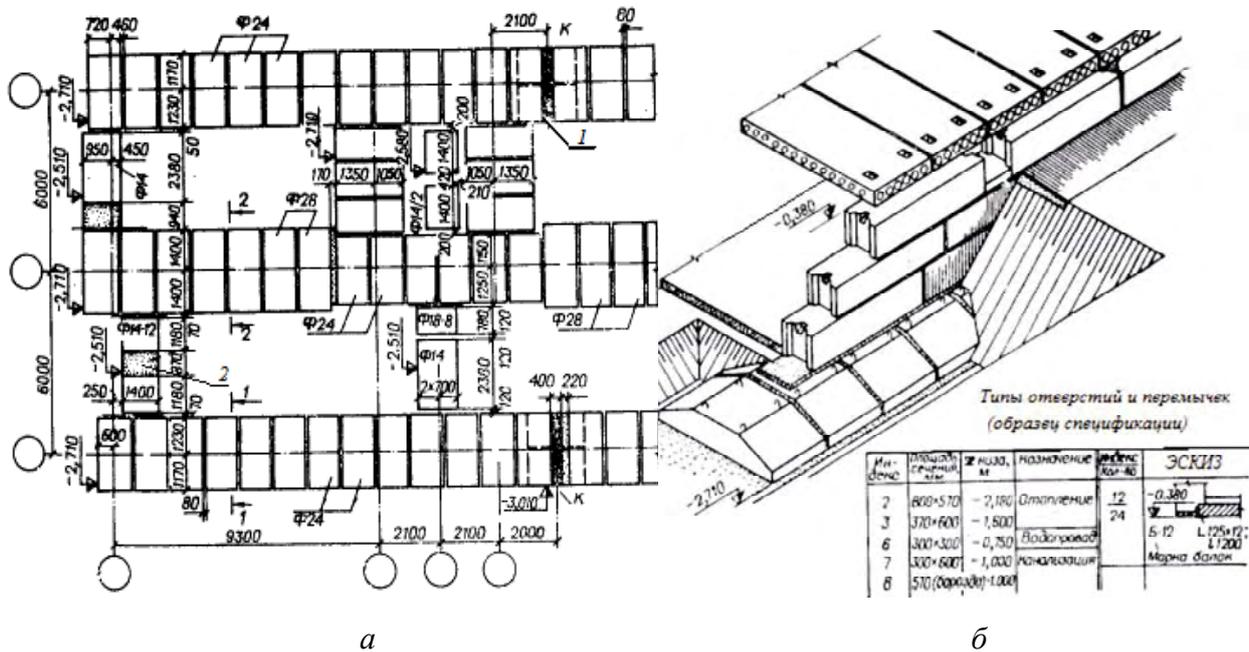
Ленточные блочные фундаменты кирпичных крупноблочных зданий: *а* — план подошвы фундамента; *б* — общий вид наружной стены: 1 — отверстие для канализации 400 × 800, низа — 3,010 мм; 2 — заделка бетоном марки 100
